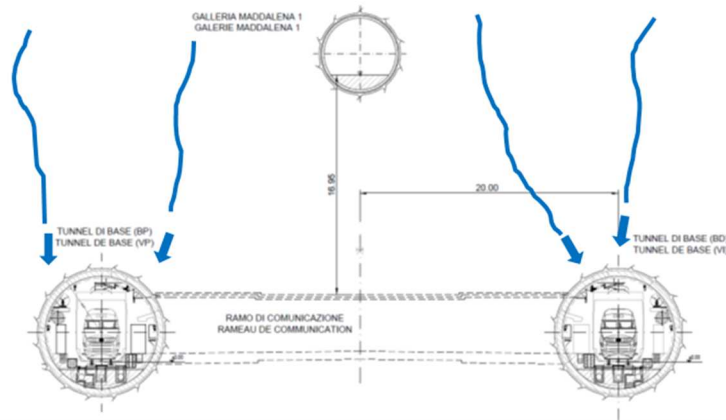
Sezione trasversale di Maddalena 1 con il Tunnel di Base
